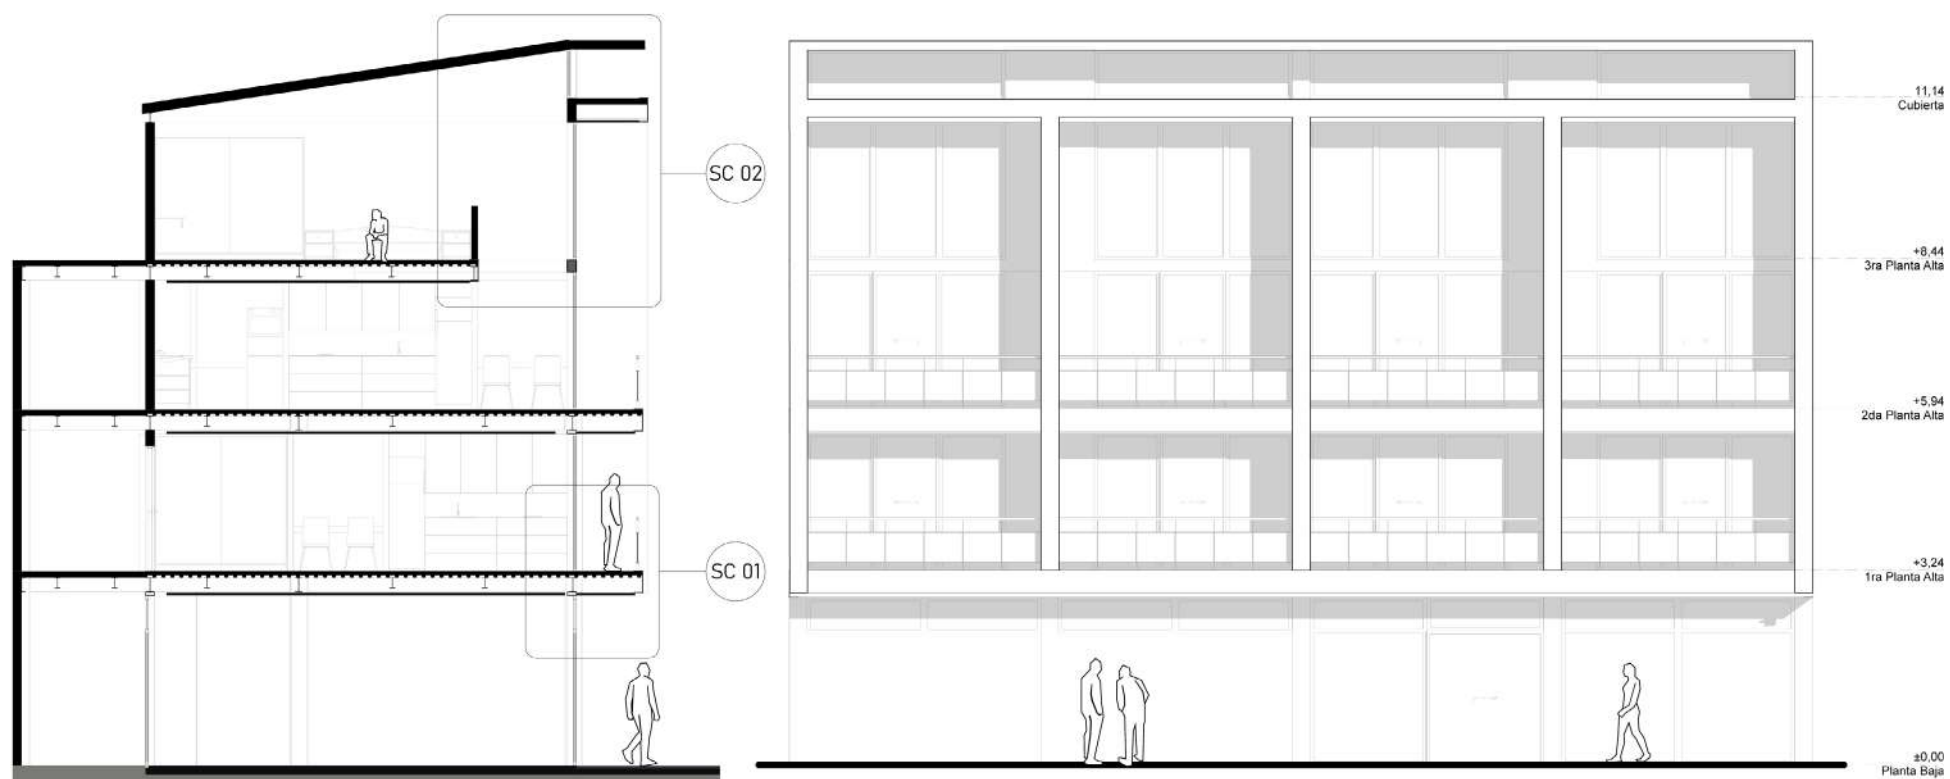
Sección confrontada con fachada Fuente: Elaboración Propia
